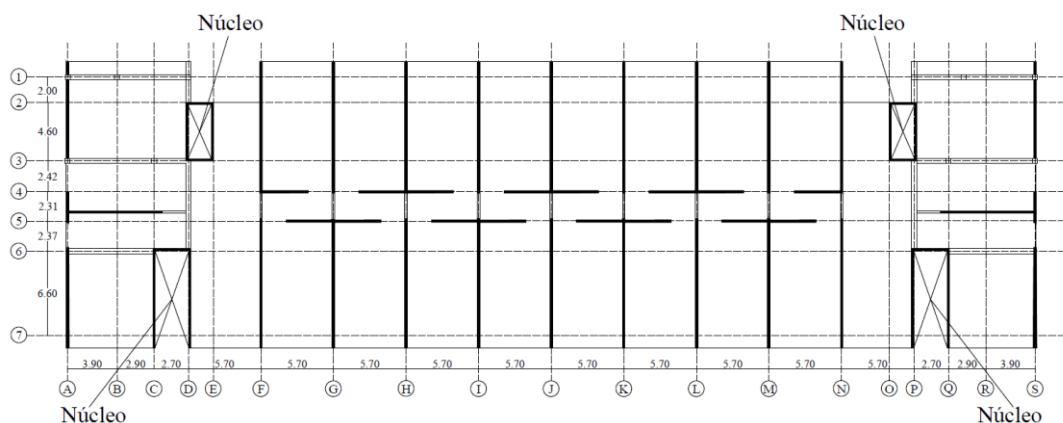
Configuração estrutural do 2º ao 7º piso do edifício em betão armado (paredes a cheio)
